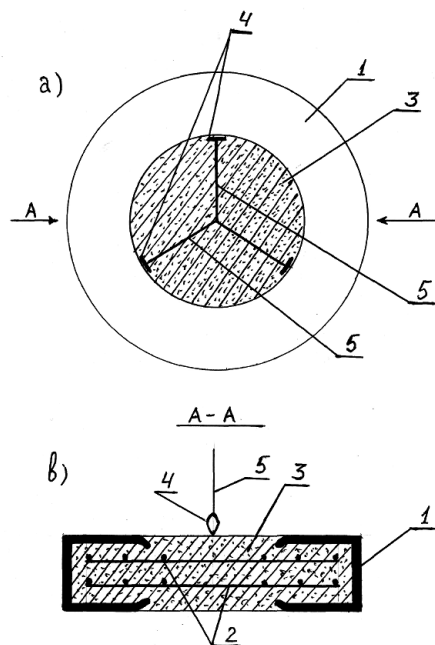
Плитная трамбовка: а) вид сверху; б) продольный разрез
